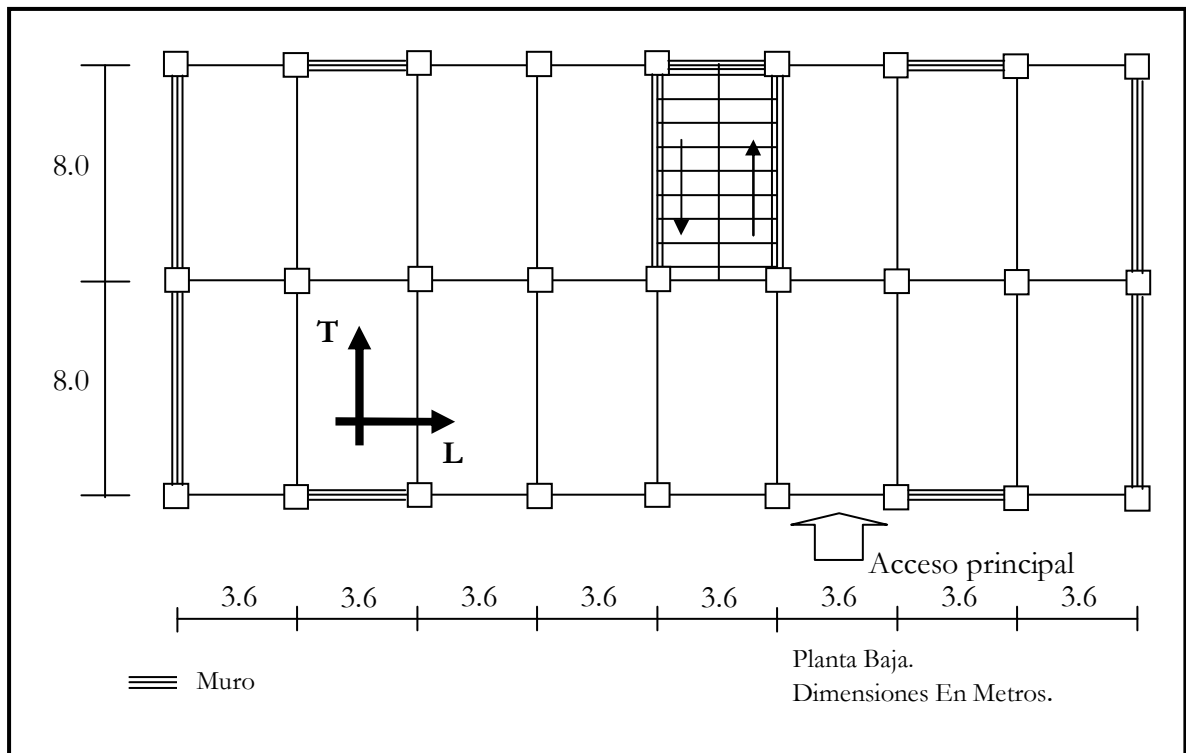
Planta Baja del edificio del Instituto de Ingeniería.
